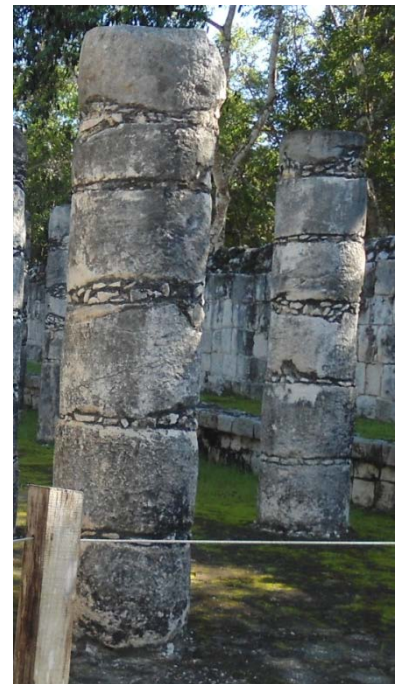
Detalle de los tambores y capitel en el lado poniente del Grupo de la Mil Columnas
